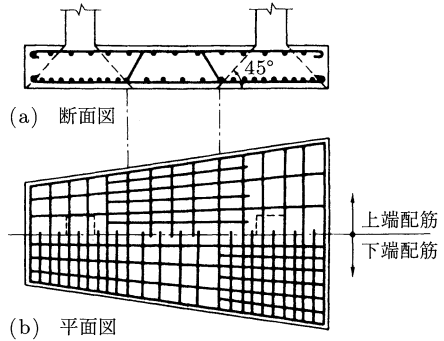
複合基礎の配筋例 (RC 配筋指針)
